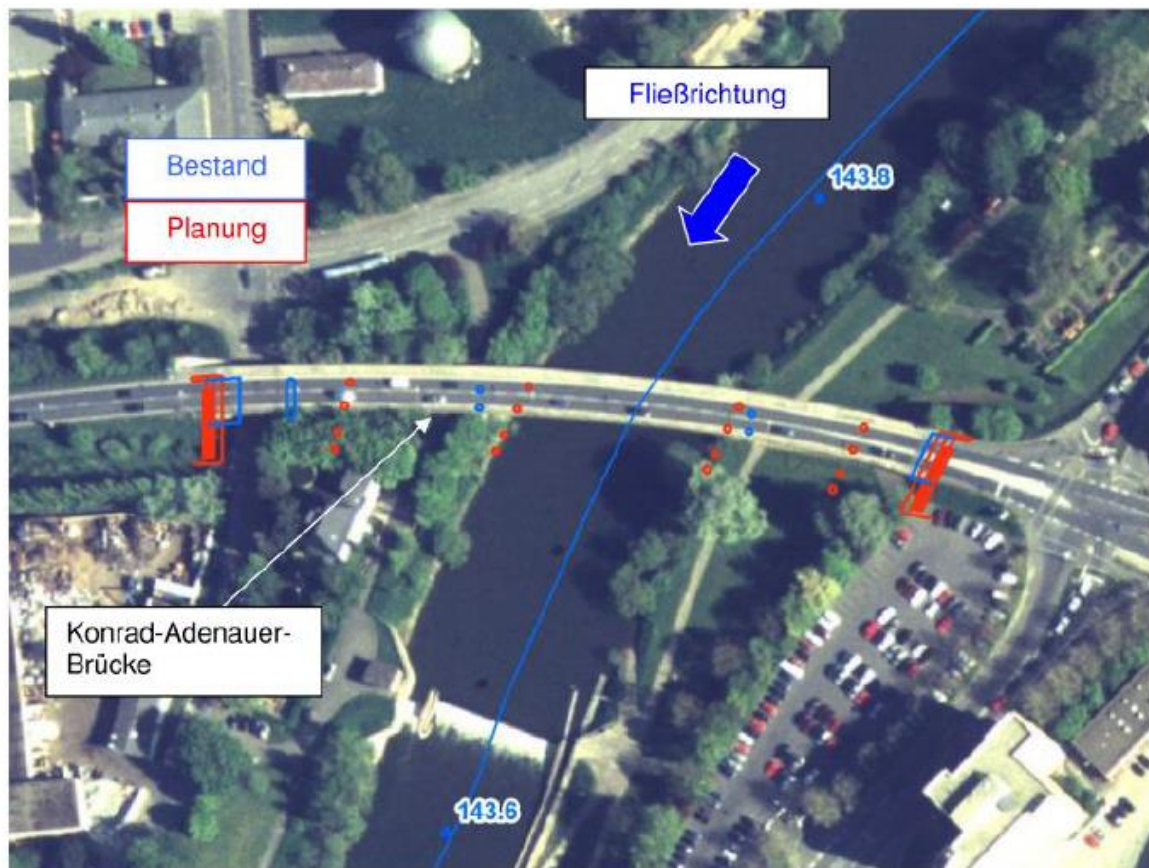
Lageplan Brückenerweiterung, Vergleich Bestand und Planung; aus: /8/
